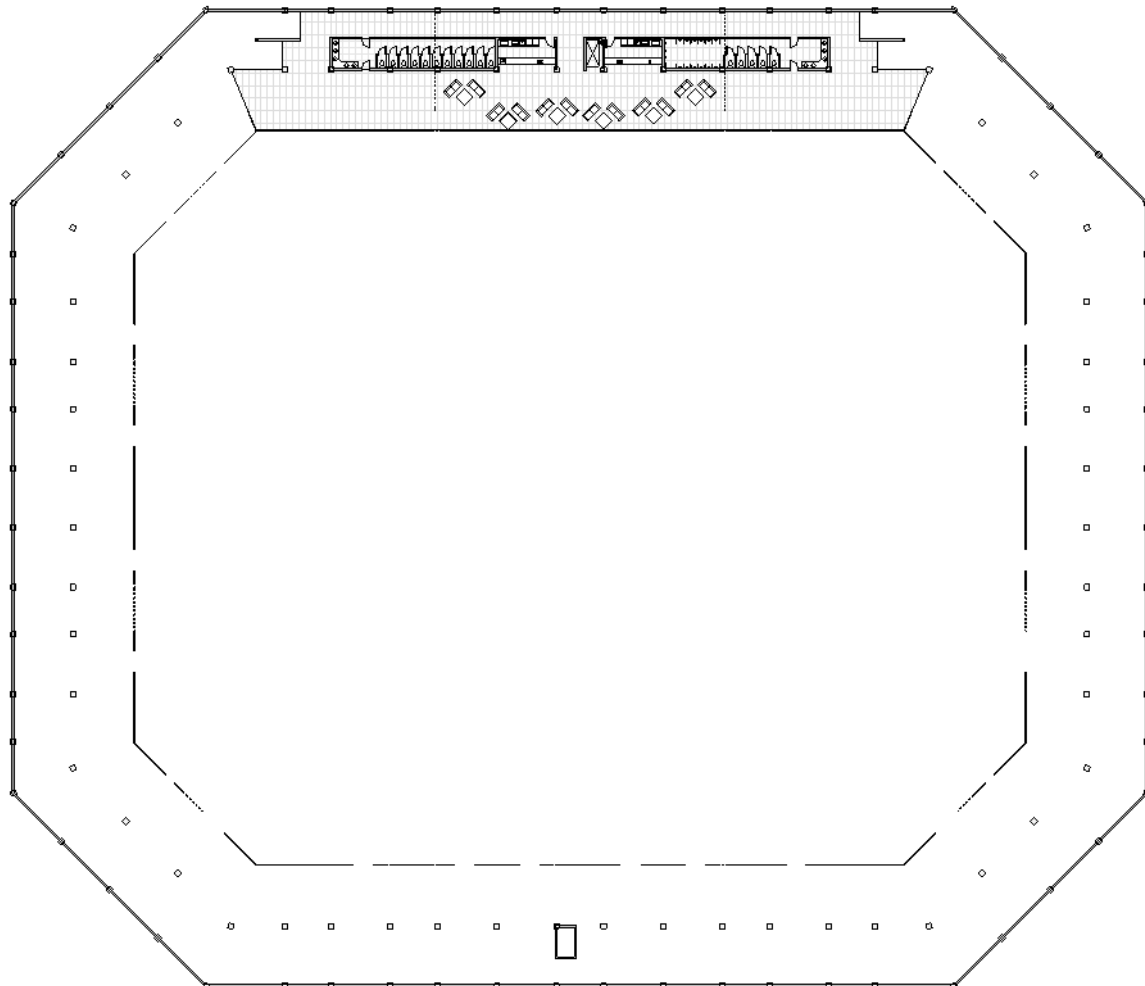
Vista en planta del segundo piso. Fuente: elaboración propia.
